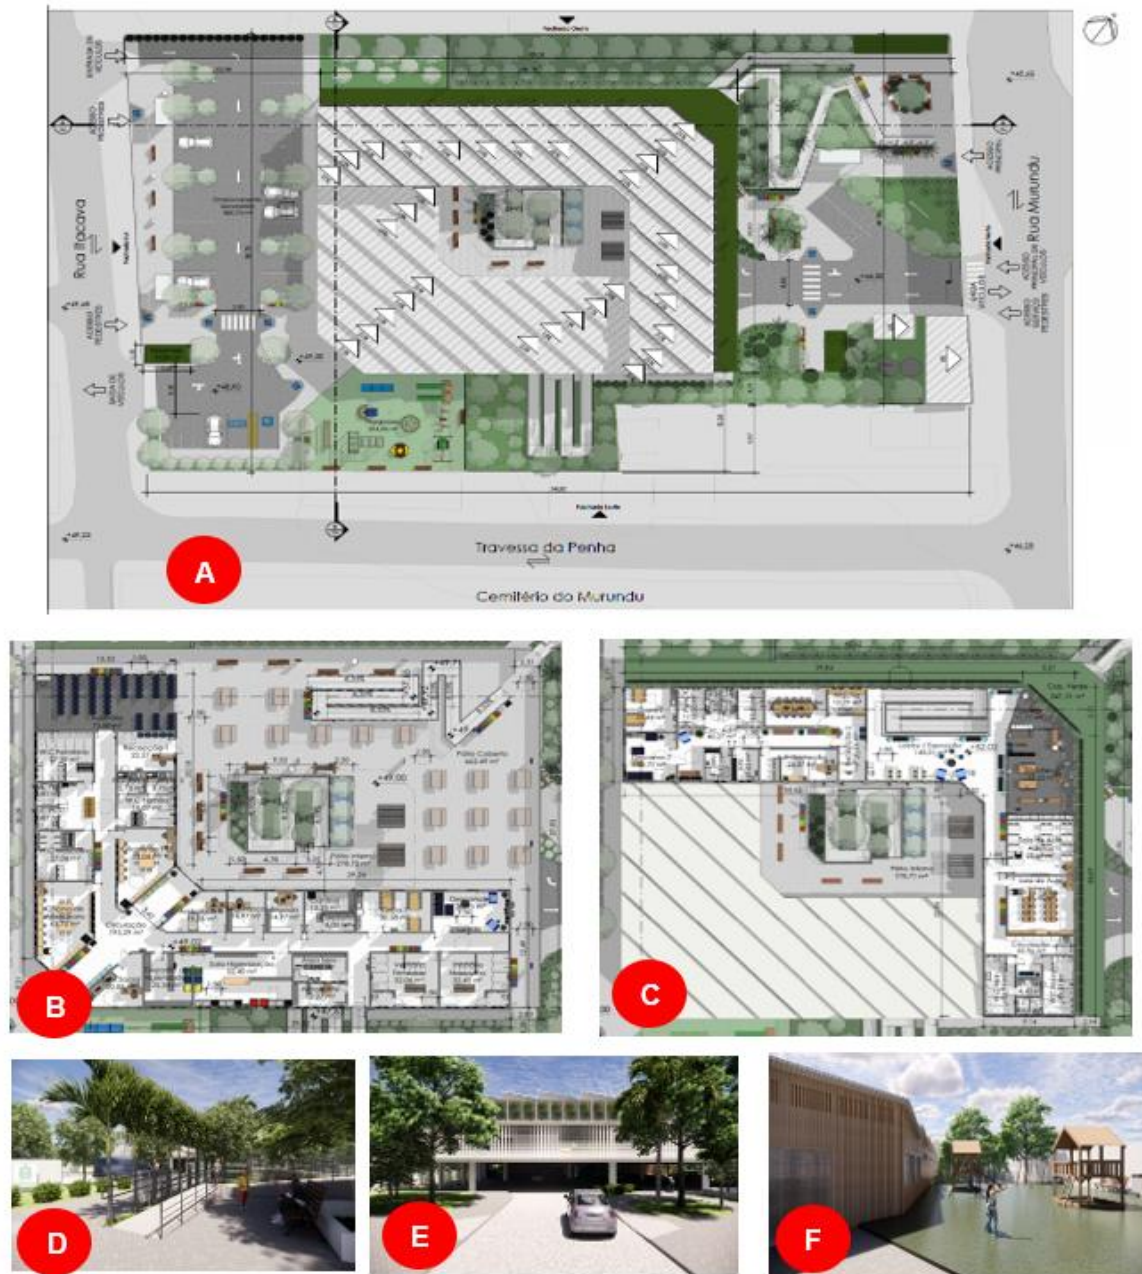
Mosaico de fotos do projeto concluído: A - Implantação; B – Planta Baixa do Térreo; C – Planta Baixa do 1º Pavimento; D, E, F – Perspectivas Externas.
